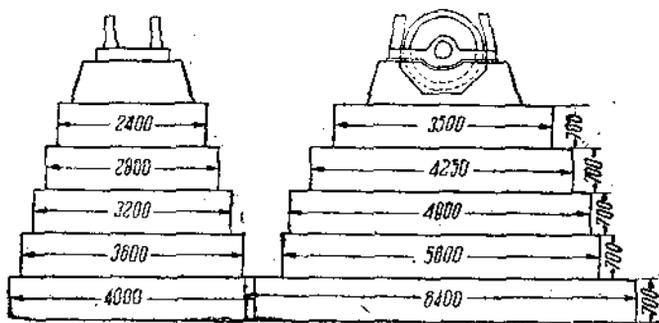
Фундамент для лесопильной рамы типа Болиндера.
